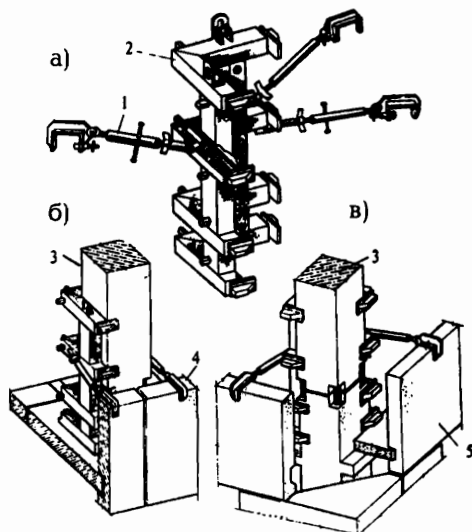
Манипулятор для монтажа панелей наружных стен: а – вид манипулятора; б, в – крепления фасадных и угловых панелей; 1 – монтажная связь со струбциной; 2 – рама кондуктора; 3 – колонна; 4, 5 – панели
